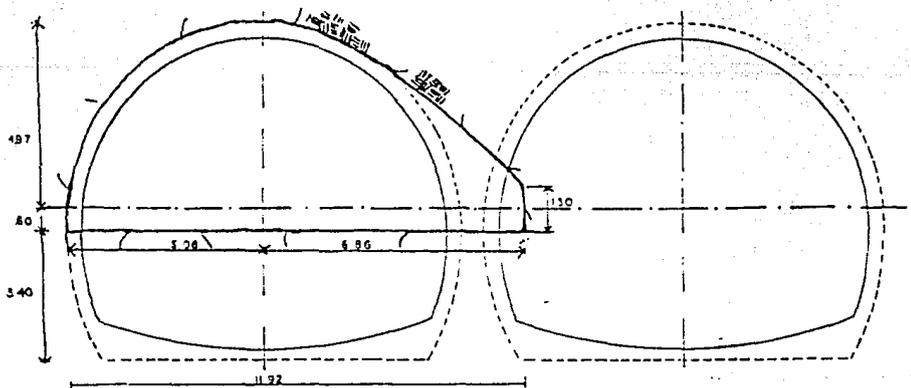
PRIMERA ETAPA DE EXCAVACION.
